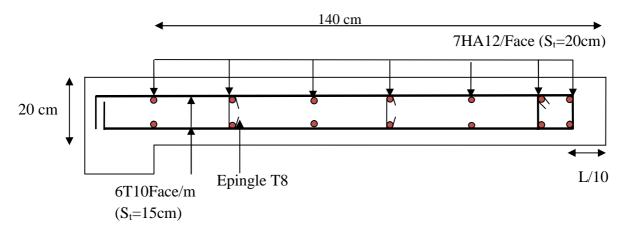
Schéma de ferraillage du voile Vy1 du $\mathbf{1}^{\mathrm{er}}$ entre sol
